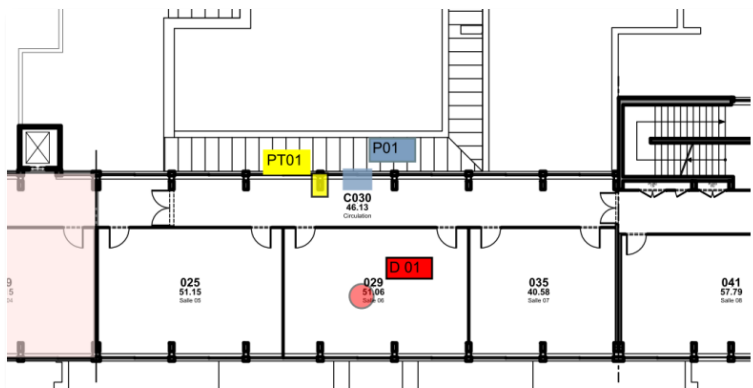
Localisation de la zone sondée, vue en plan, bâtiment Est
